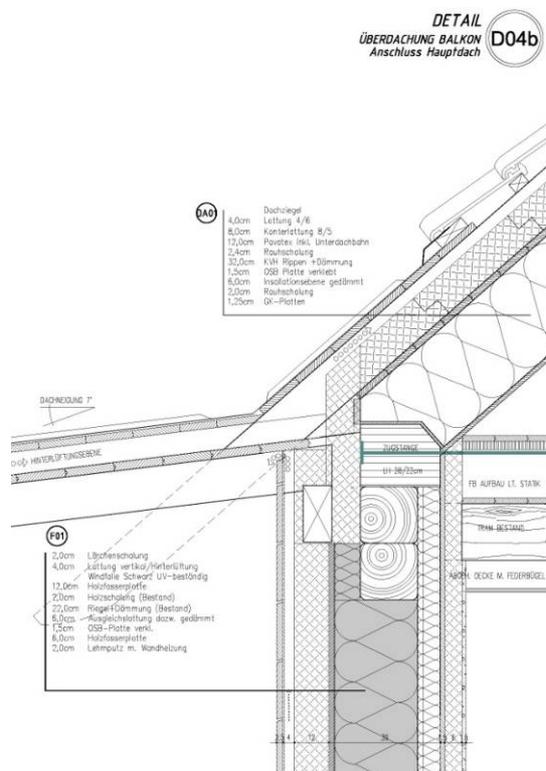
Detail Holzriegelwand mit Anschluss Balkon
